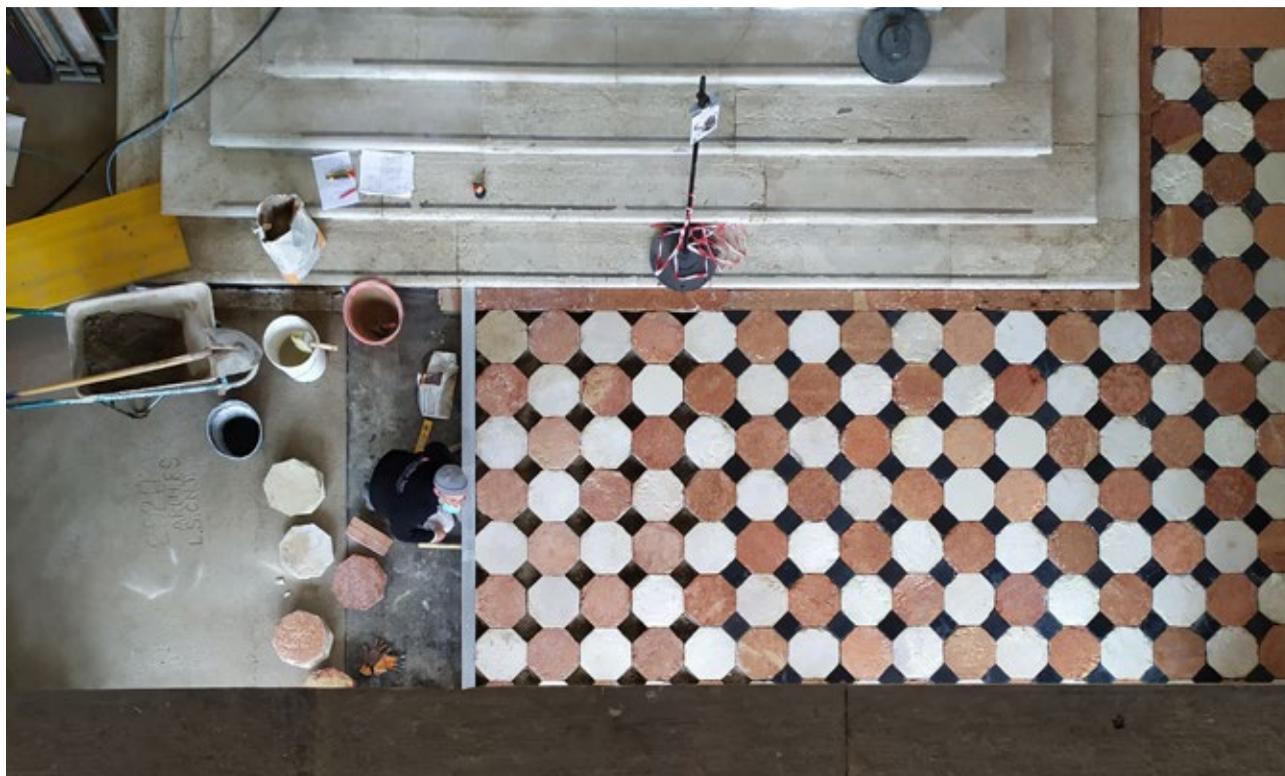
Smontaggio e ricollocazione degli ottagonni del pavimento
